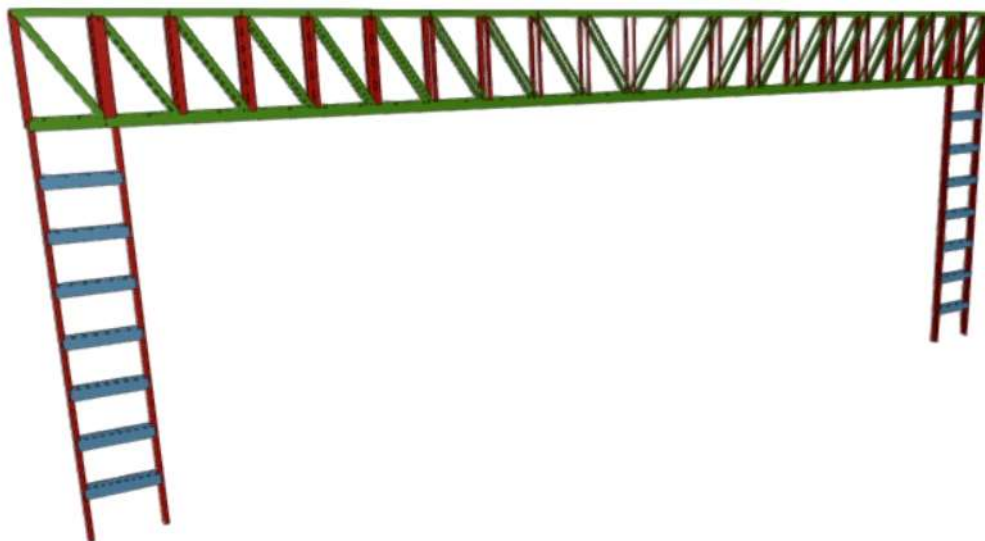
PÓRTICO DE LA NAVE DE TALLERES.
